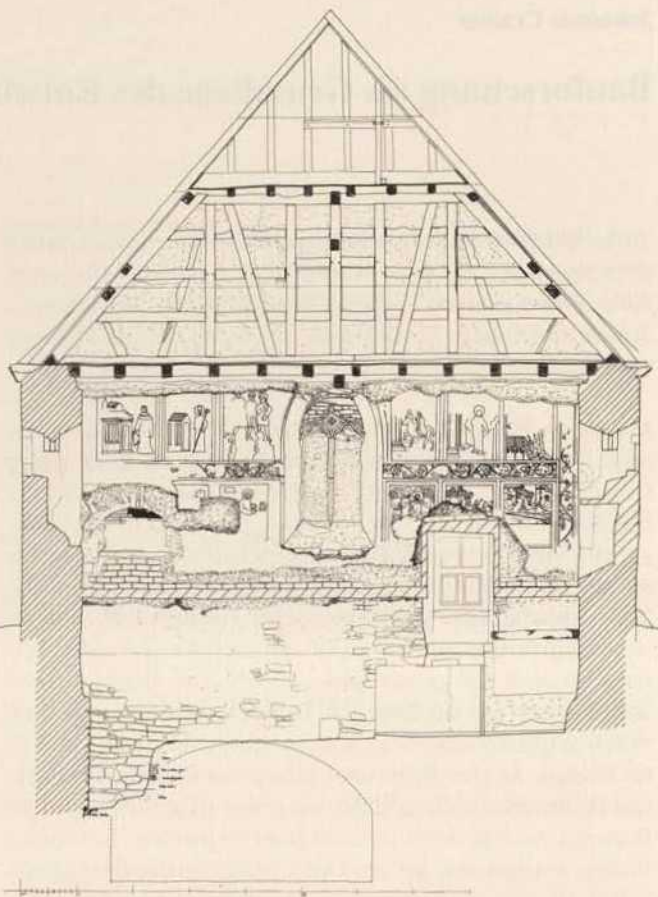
Owen unter Teck, Bauernhaus in einem ehem. Kirchenbau. Querschnitt; Ostwand mit gekapptem Maßwerkfenster und großflächig erhaltener Wandmalerei des 14. Jhts. Die Darstellung einer Heiligenlegende ist im unteren Wandbereich durch den Einbau einer Decke (1946) und die Stallnutzung (seit 1877) weitgehend zerstört. Die Mauerkrone wurde 1877 um etwa einen Meter reduziert.
